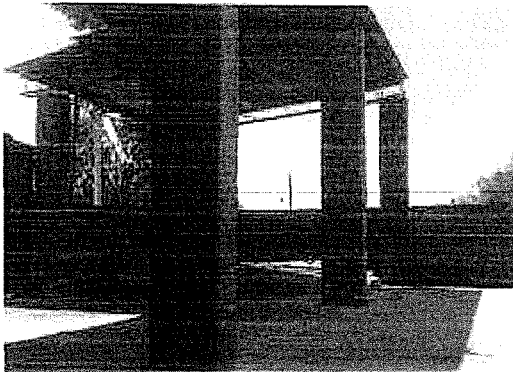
Área de secado-Maquina Toulfline (retirada) 2do piso
